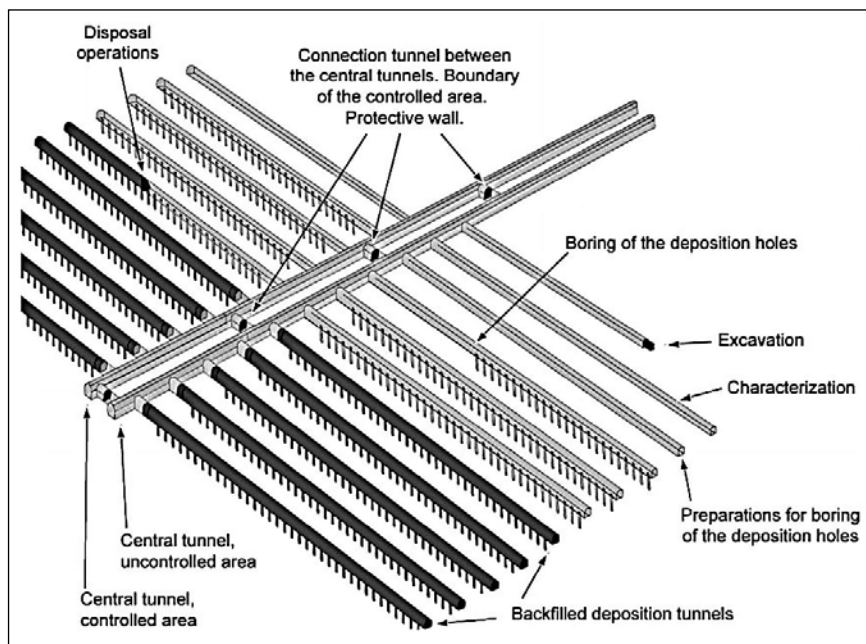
Схема сдвоенных центральных туннелей хранилища.
